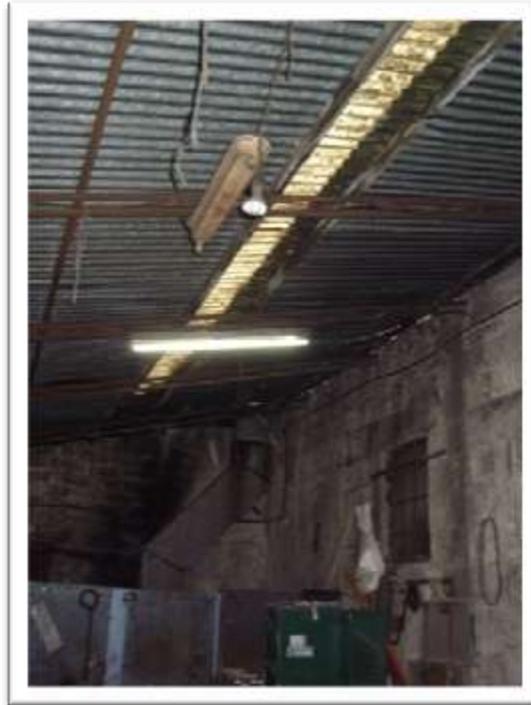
Lotto n.1 – Locale deposito - Foglio 9, P.la 311, sub 1
